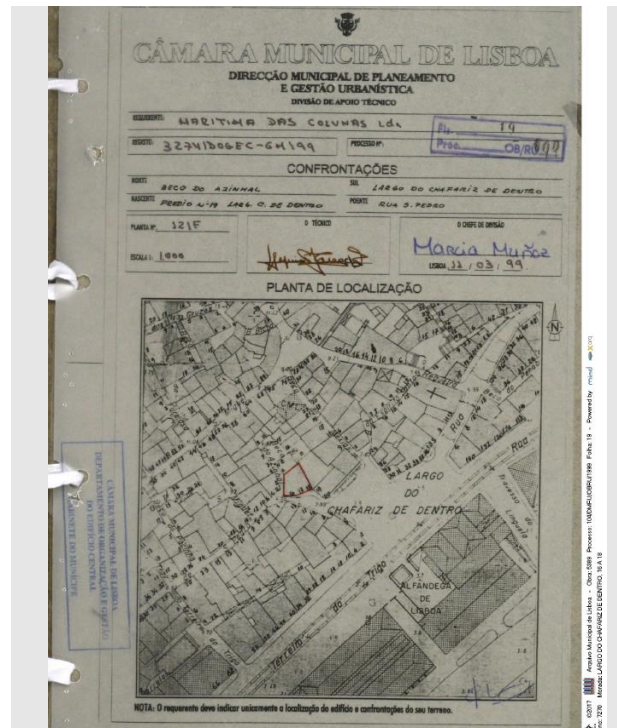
Planta de Localização da Casa das Colunas, in AML.
